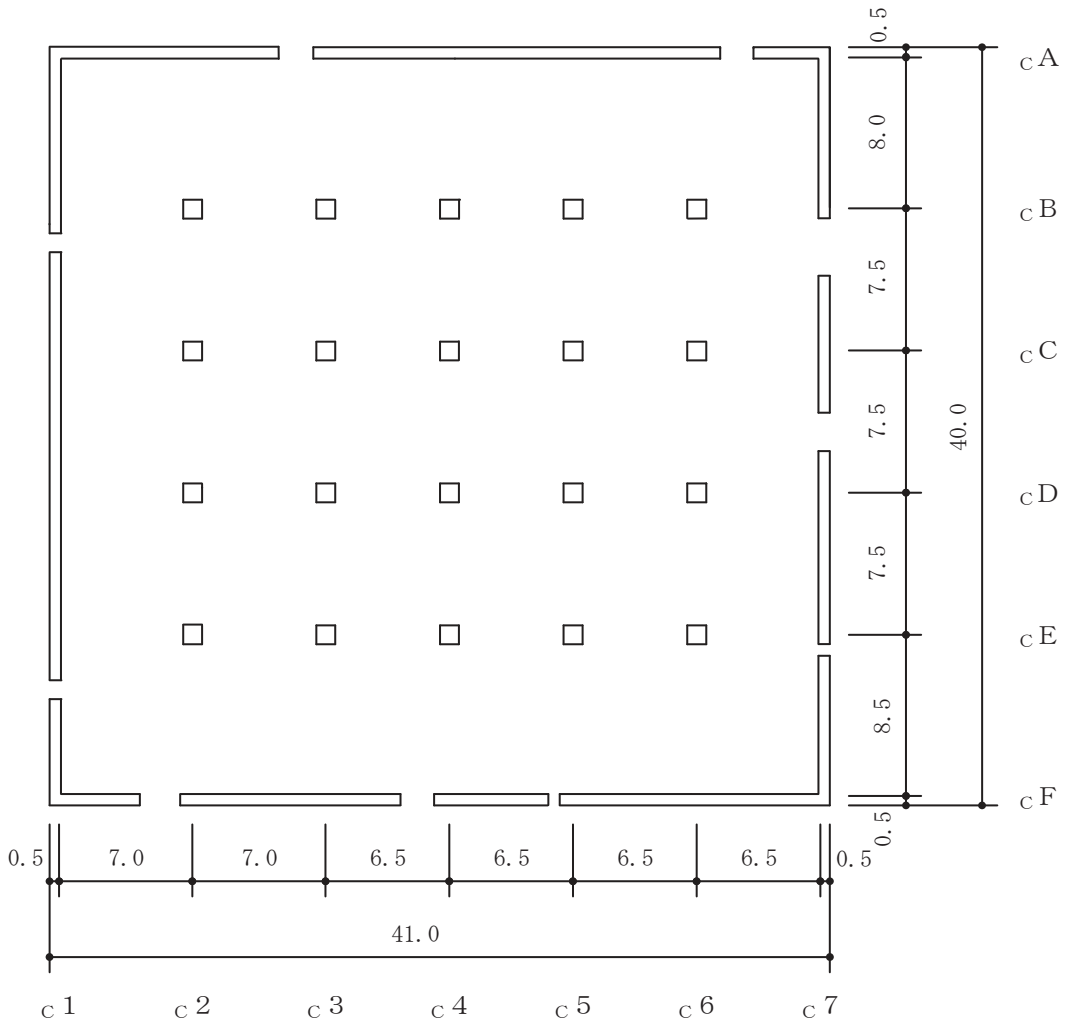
(1) 制御建屋の概略平面図 (0.P.*1.5m)
